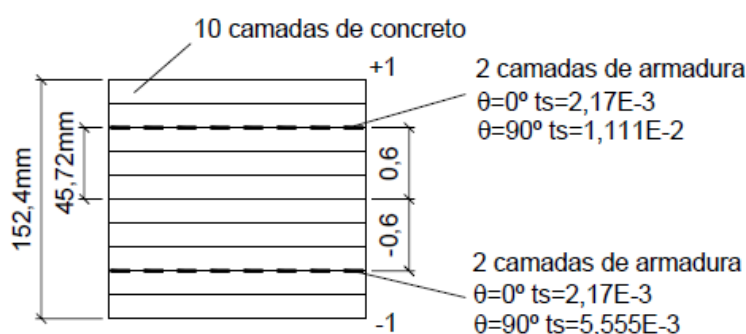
Camadas de concreto ao longo da espessura da laje (DIAS, 2013)
